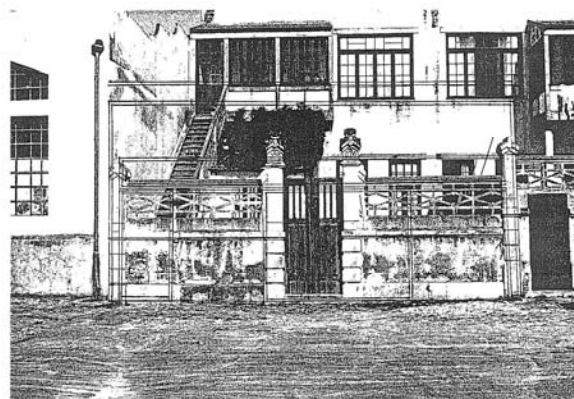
Edifício nº9 em 1959 antes da construção da garagem e armazém (alçado posterior) [29].
